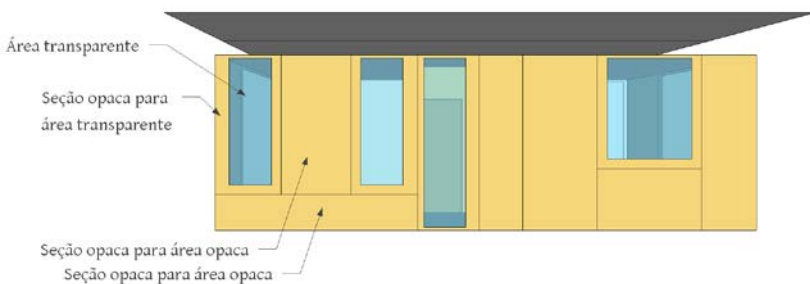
Ilustração das seções de parede na fachada sul. Fonte: autor.
